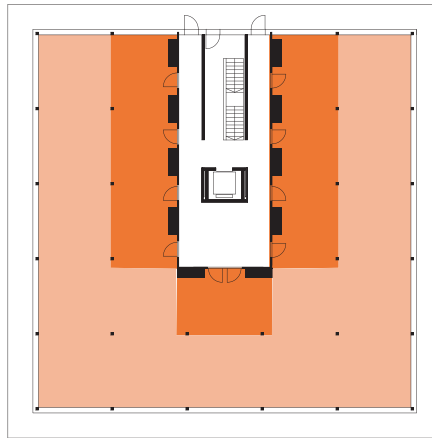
Installationsboden: Eine horizontale Trasse im Bereich der Erschließungszone ermöglicht zusammen mit einer vertikalen Installationsführung im Boden eine hohe Flexibilität. In dieser Variante können alle Medien geführt werden. In dem projektierten Gebäude werden zwei Zonen mit einem unterschiedlichen Bodenaufbau ermöglicht. Der nahe der vertikalen Trasse liegende Bereich ist für die Aufnahme aller Medien geeignet. Der Bereich an der Fassade kann keine Abwasserleitungen aufnehmen. Obwohl der im Forschungsprojekt entwickelte Installationsboden eine flexible Naßzonen-gestaltung ermöglicht, wurde im Planungsteam die eingeschränkte Flexibilität aufgrund der architektonischen Typologie und der damit verbundenen Raumzonierung mit einem dienenden, dunklen Bereich bevorzugt.
